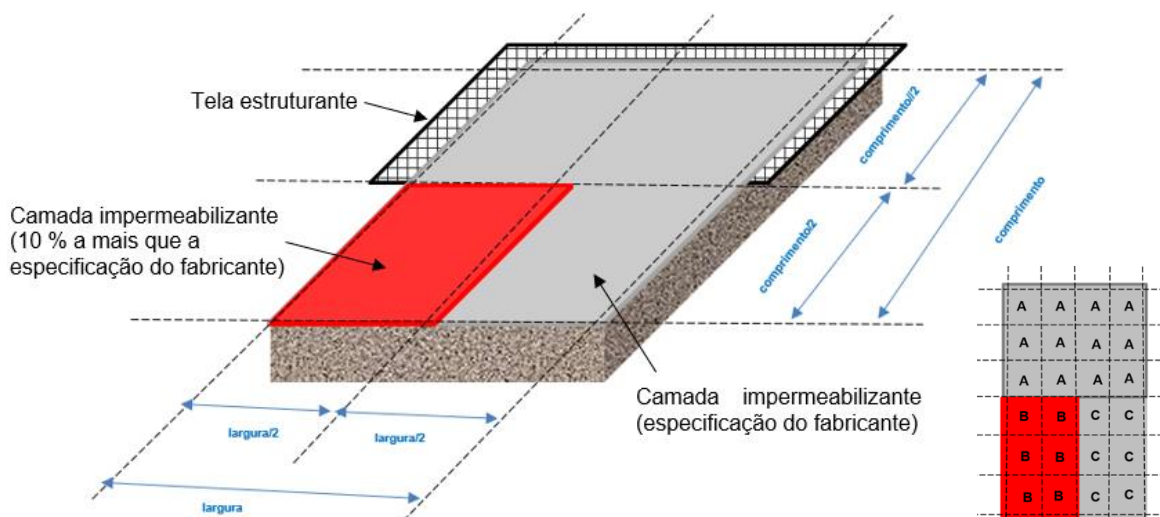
Detalhamento da aplicação das camadas impermeabilizantes de membranas acrílicas sem cimento nas placas de concreto. Corpo de Prova Tipo A: com tela estruturante e camada de impermeabilizante conforme instruções do fabricante; Corpo de Prova Tipo B: com camada de impermeabilizante 10% maior que a instrução do fabricante; Corpo de Prova Tipo C: com camada impermeabilizante seguindo instruções do fabricante (sem tela).
